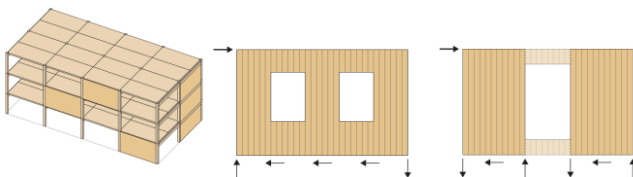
Eksempel på etageplaner med afstivende elementer fx vægge eller gitre, der udgør stabile systemer.
